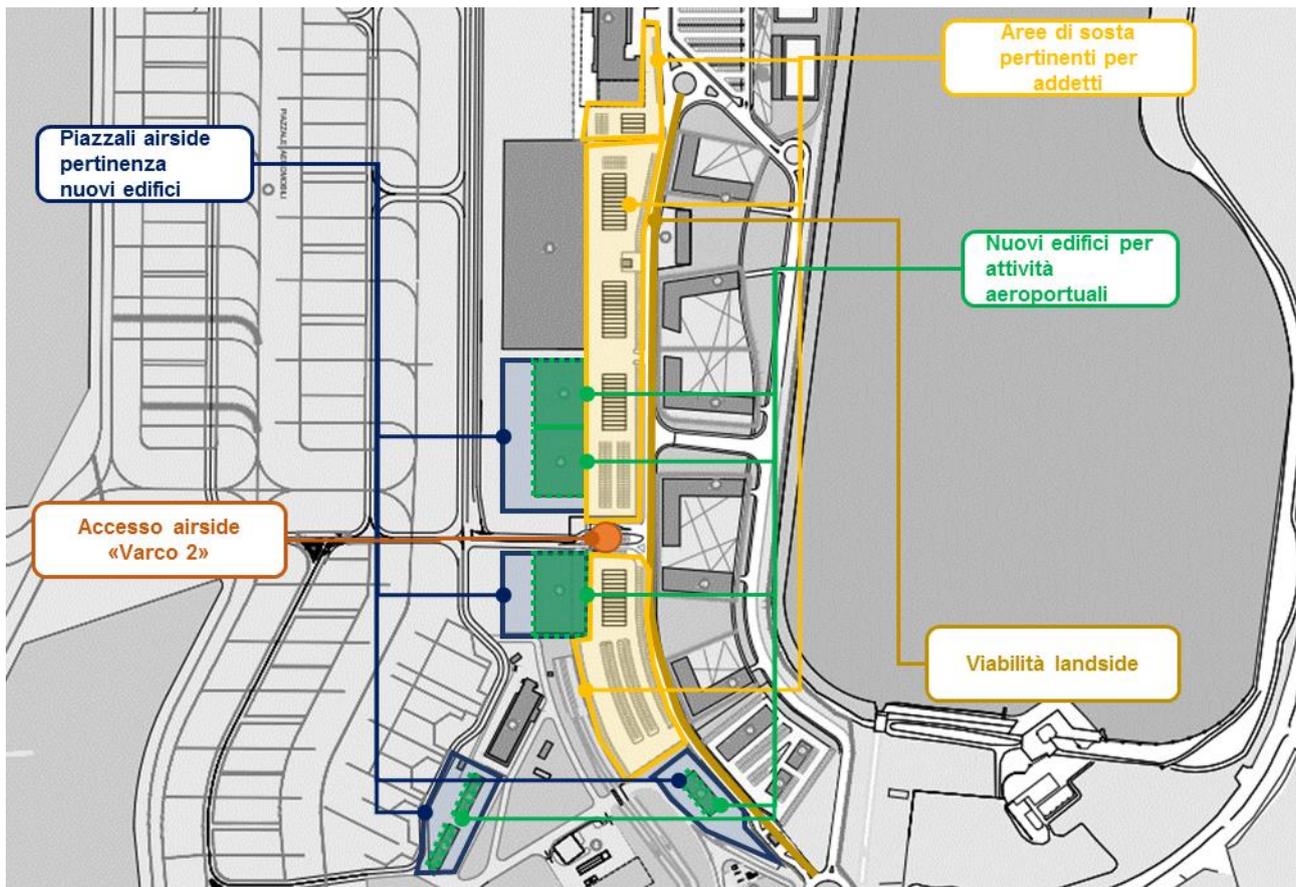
Strutture di supporto aviazione commerciale: Realizzazione di nuovi edifici per ricovero mezzi, uffici ed officine e aree piazzale pertinenti (Fonte: Masterplan, Schede interventi – Scheda 2.5, 4.3 e 4.4)
